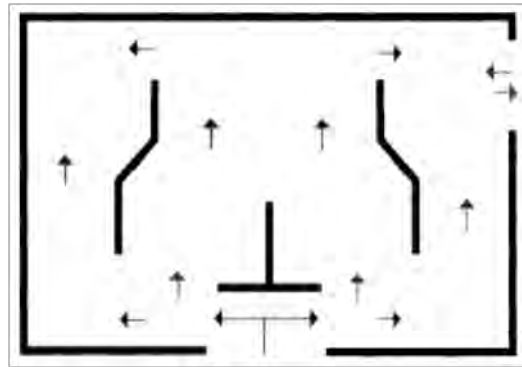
Denah pendekatan alur pengunjung dalam pameran (alur yang disarankan).
